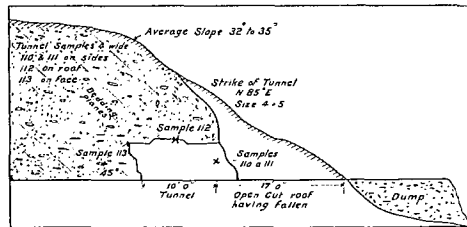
Coupe en travers du tunnel du claim minier Britannia.
